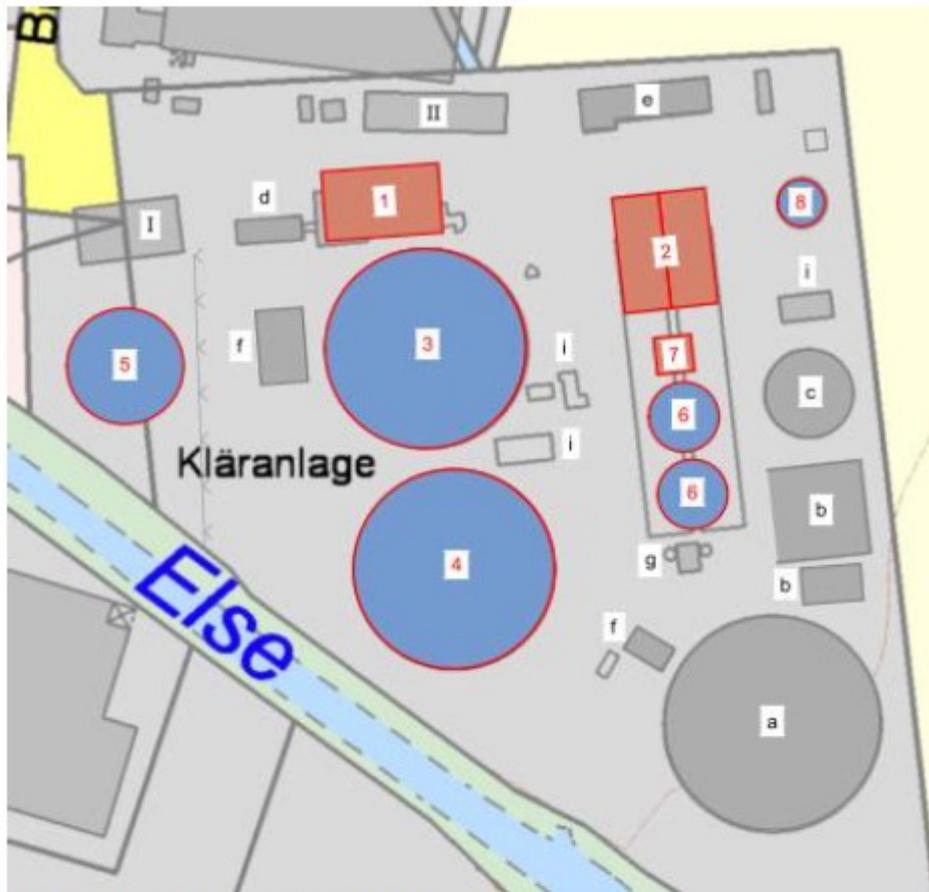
Lageplan Variante 3: Erweiterung KA Melle Mitte
